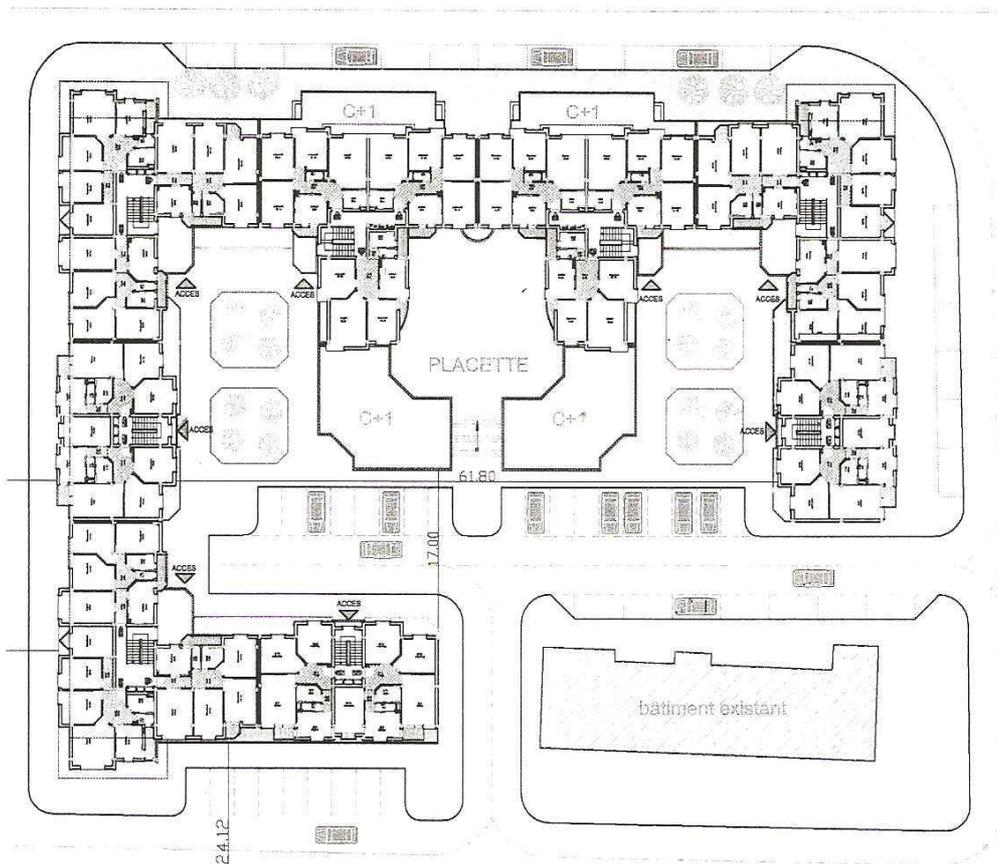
l'étage courant des immeubles LSP - échelle : 1/800 -
